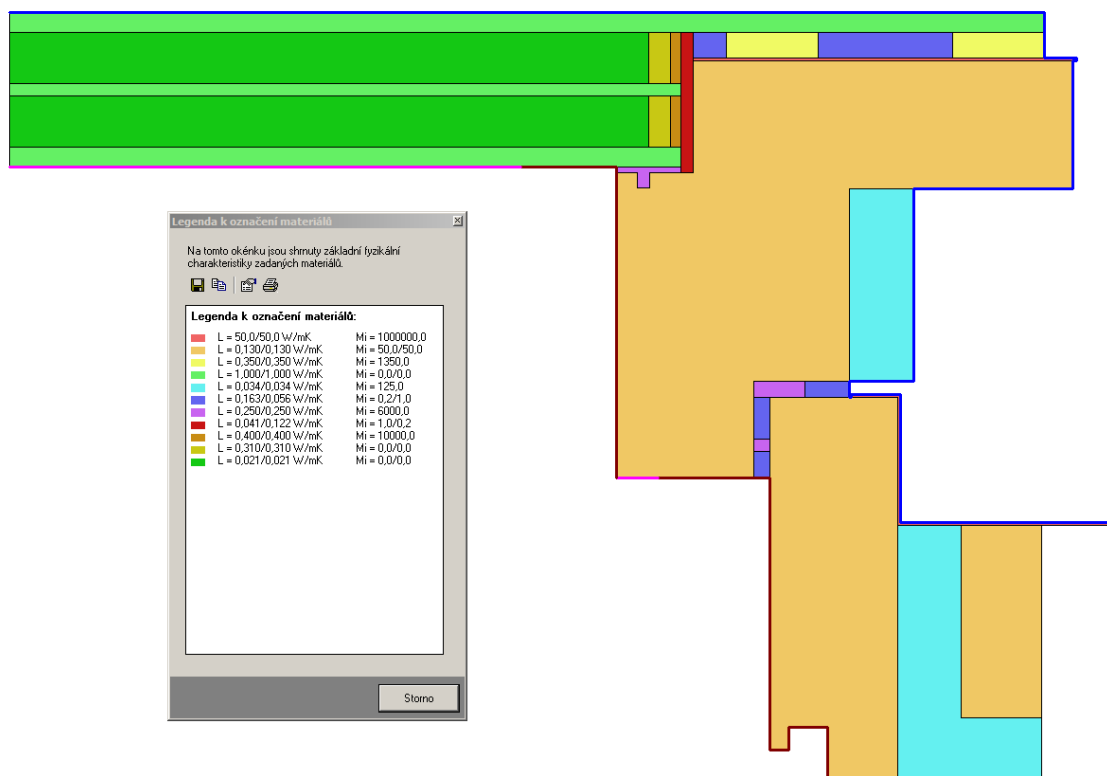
Geometrie modelu DET_B – v místě kotvy motoru dl. 80 mm
